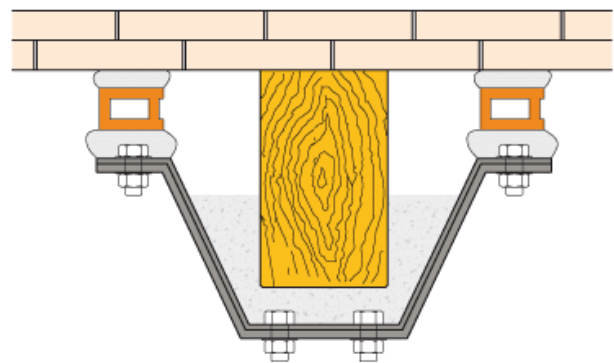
Detalle constructivo sistema MVV, portal web mecanoviga.com
